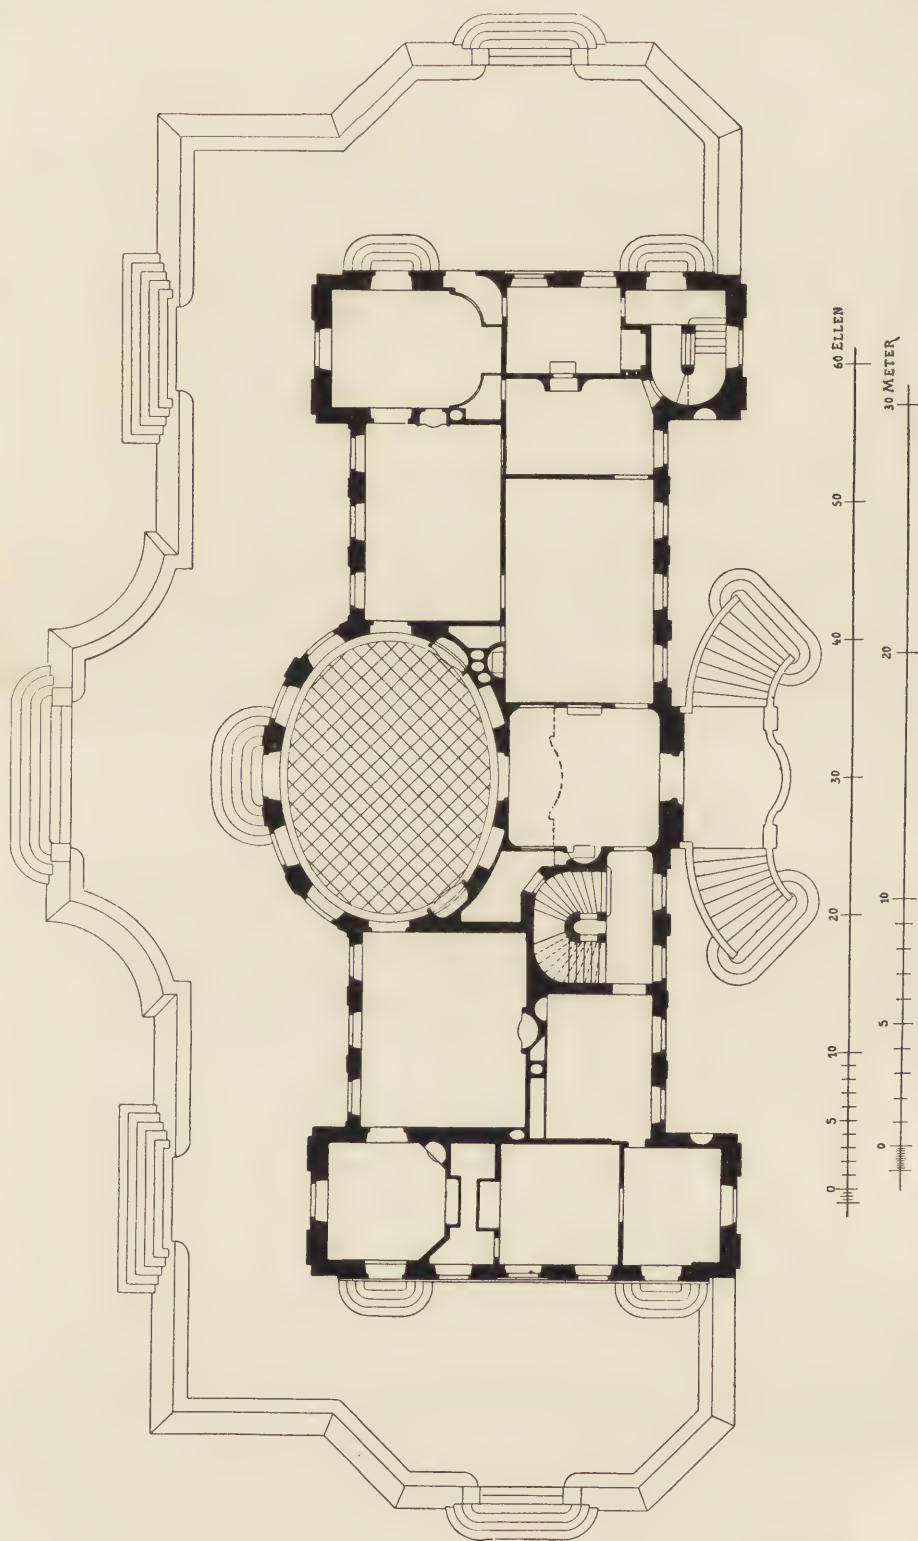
Moscinska-Palais, Grundriss des Erdgeschosses.
